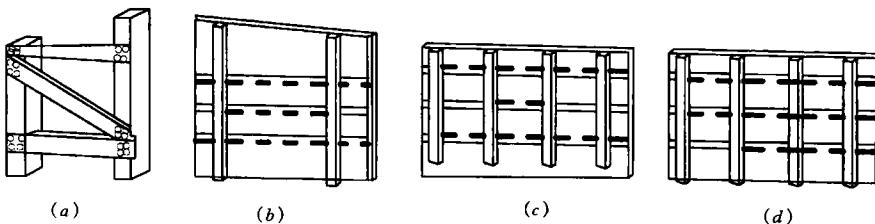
装配式钢筋混凝土 T 梁模板组合构件
